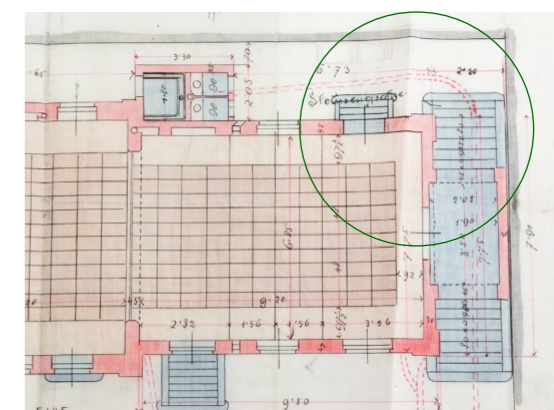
Grundriss Auswechslung (1884) [ma37]
